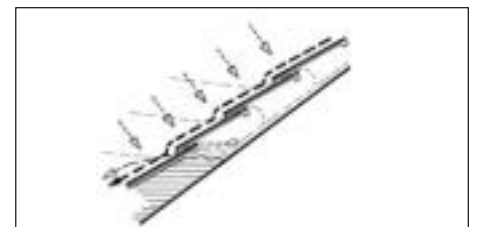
In Zusammenhang mit eisschanzengefährdeten Dachkonstruktionen führt nur das wasserdichte Unterdach zum Ausschluß klimatisch bedingter Durchfeuchtung der unteren Dachschichten.
